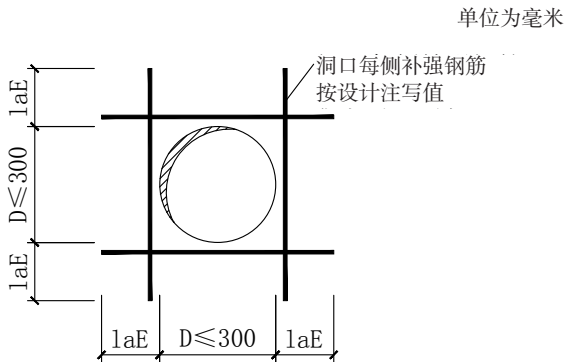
剪力墙圆形洞口直径不大于 300mm 时补强钢筋构造
